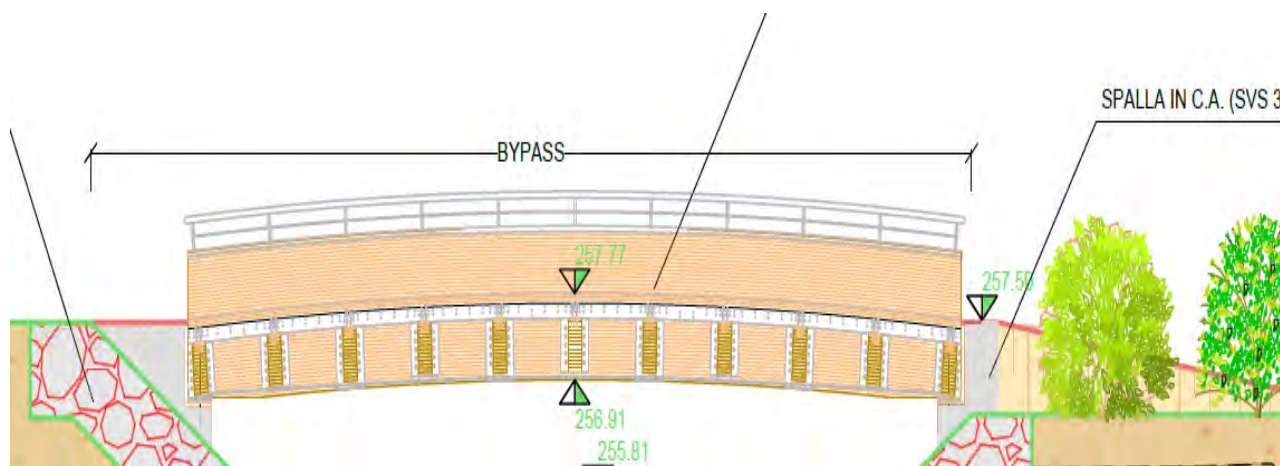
Sezione del ponte in progetto di via dell'Abbazia
